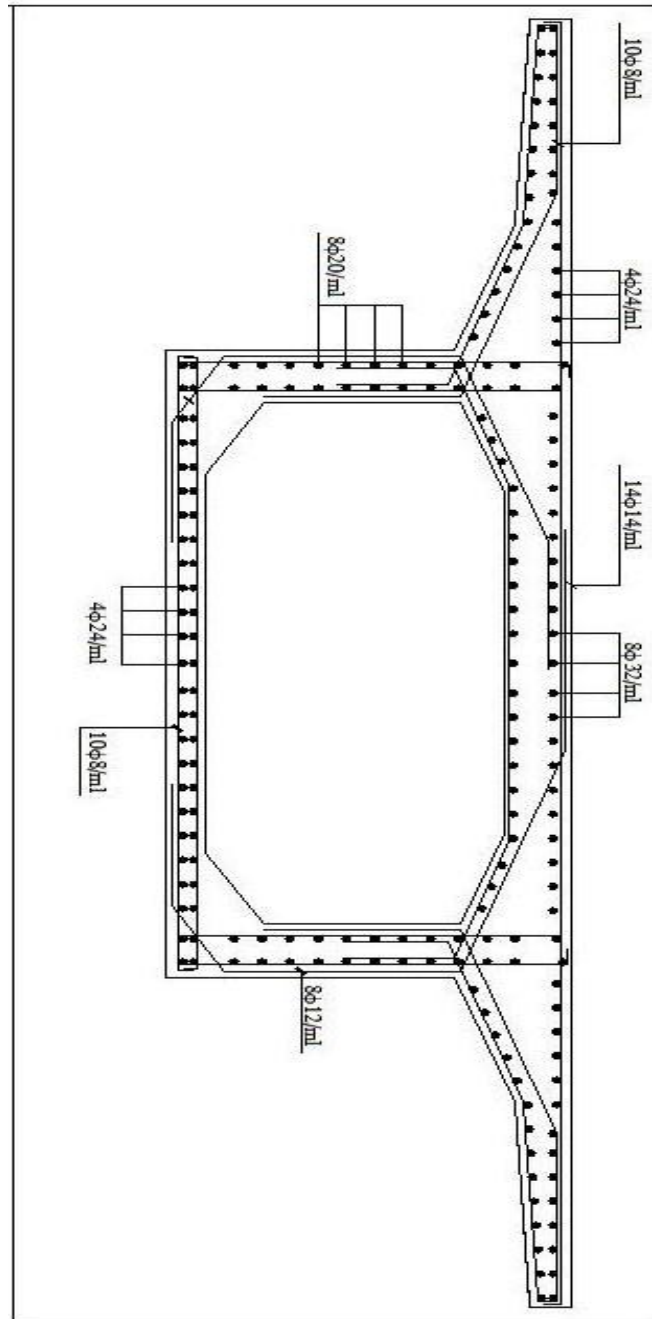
Schéma du ferrailage passif du voussoir à la clé
